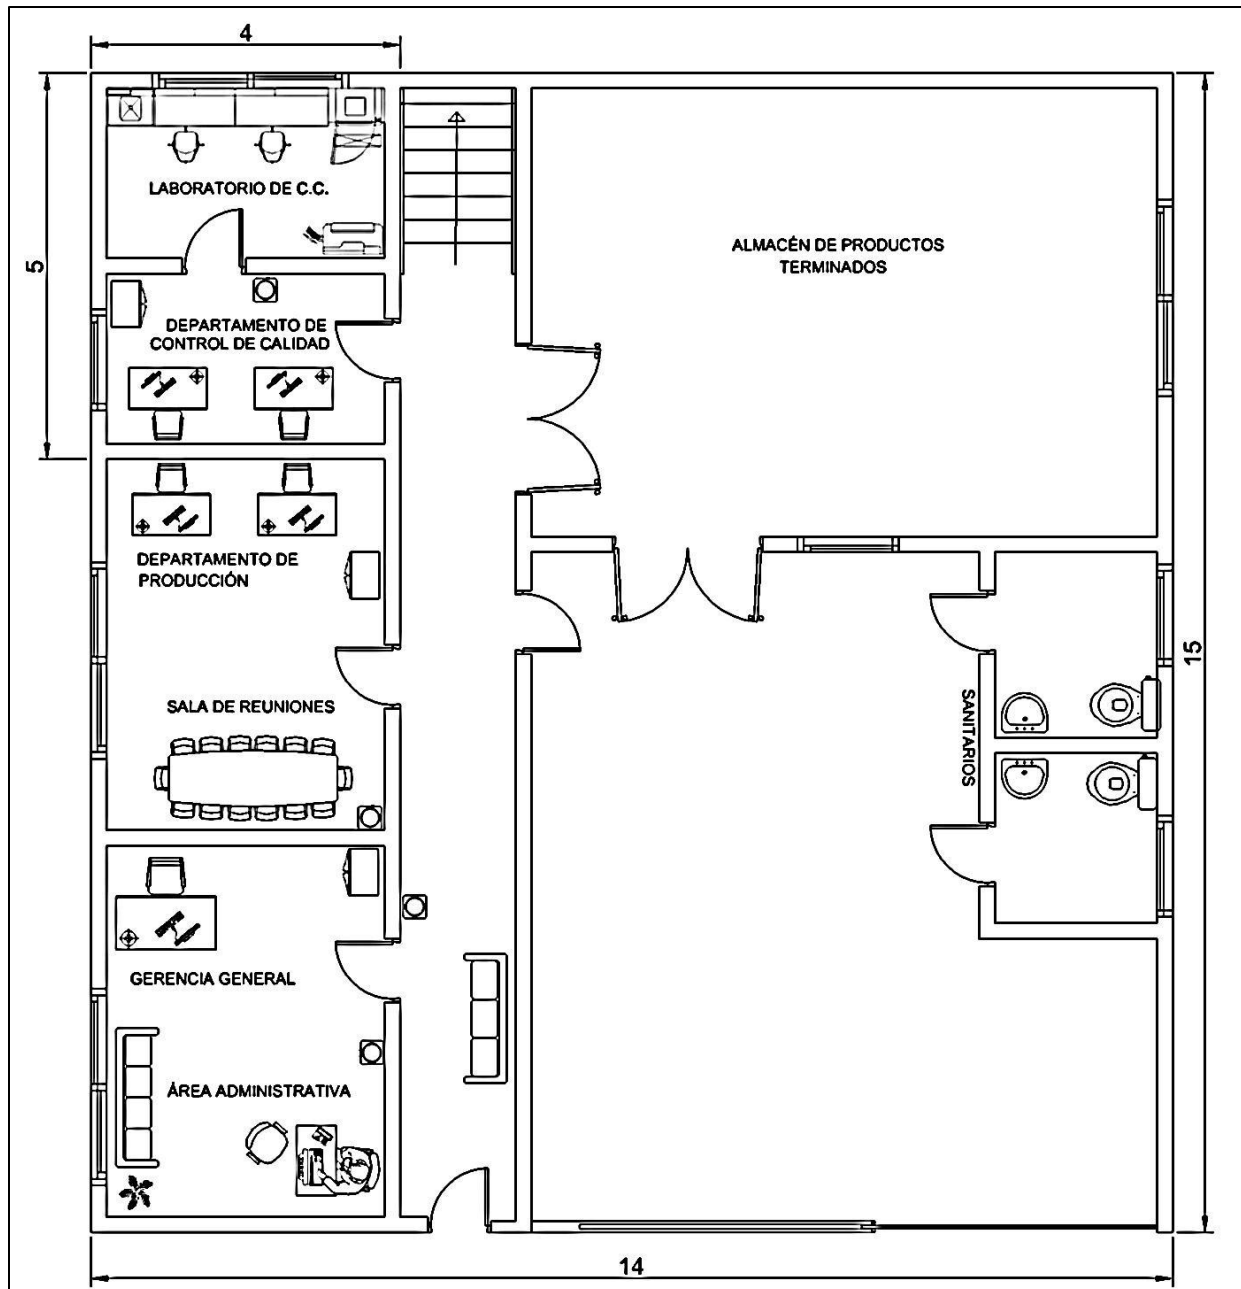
Plano: Planta Baja con la instalación del Departamento de Control de Calidad. Fuente: Rondón (2018)
